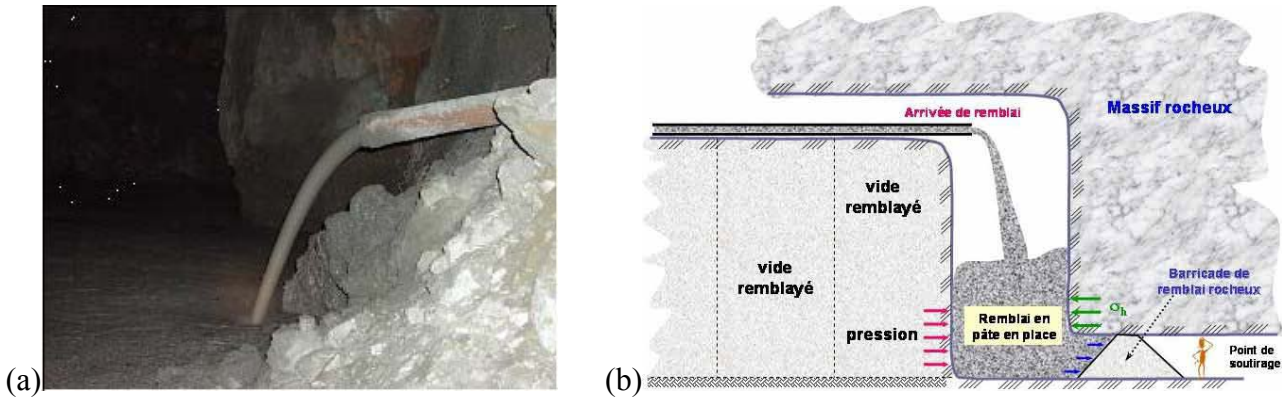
Mise en place du remblai: a) vide en cours de remblayage; b) schéma des composantes d'un vide remblayé.
